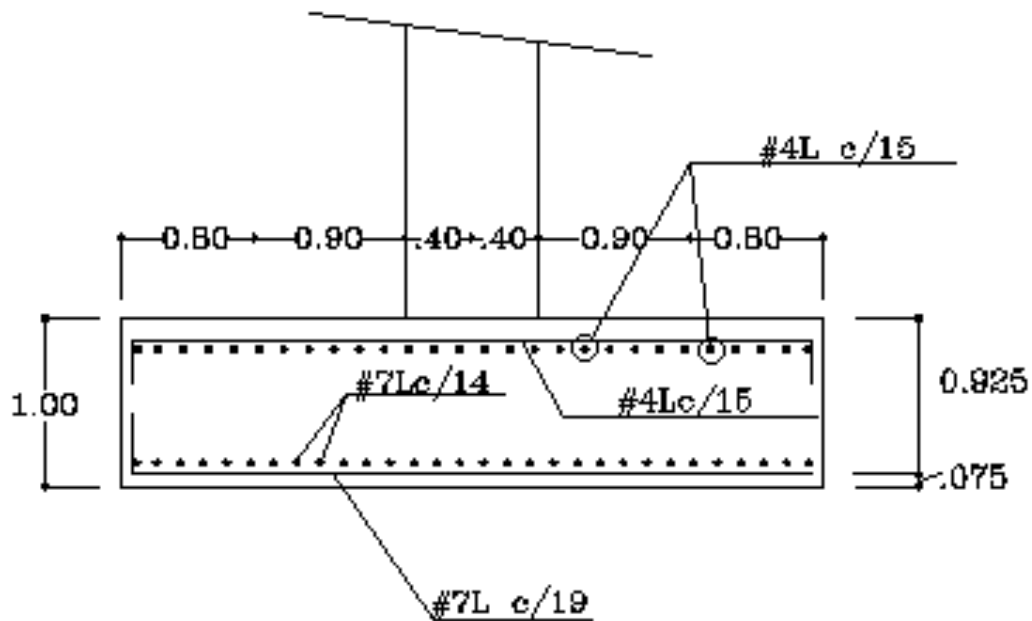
Sección transversal de dado- zapata de pórtico central (elaboración propia).
